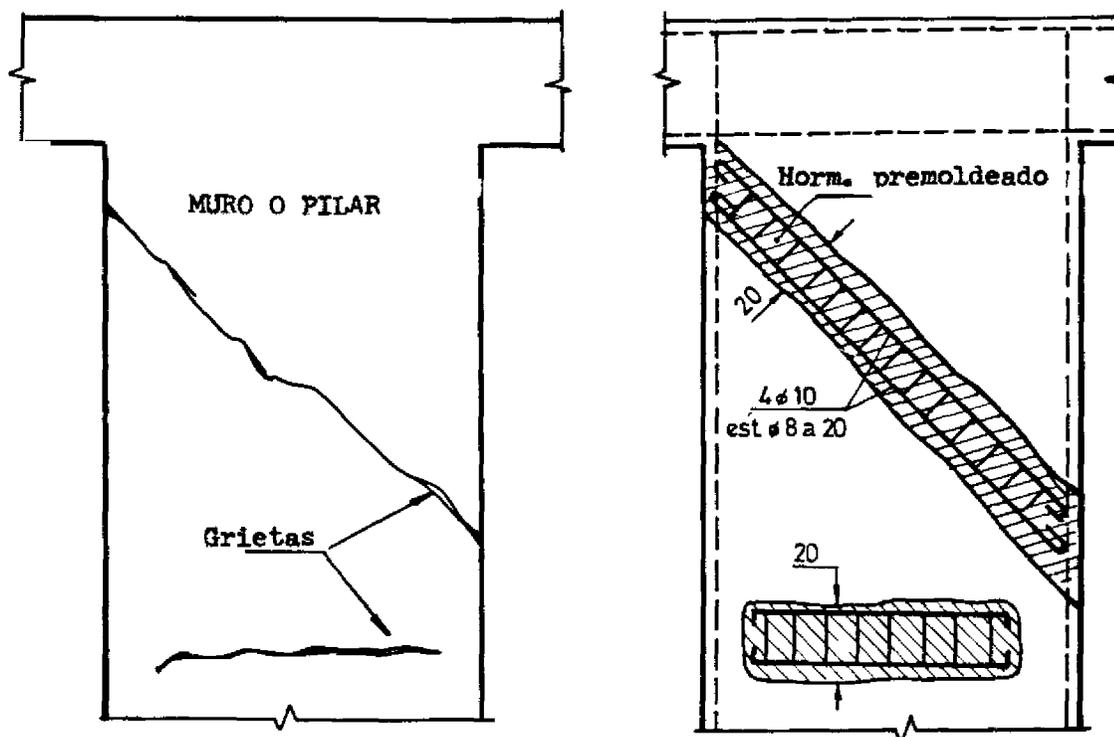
Caso M-3. REPARACION DE UN MURO O PILAR DE HORMIGON ARMADO CON GRIETA POR ESFUERZO DE CORTE (uso de hormigón premoldeado Prepakt)
